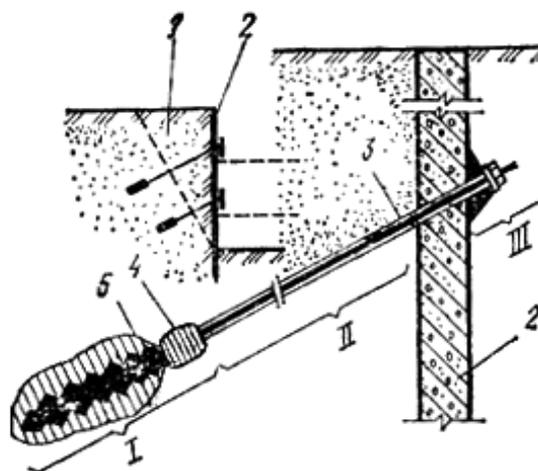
Крепление стены в грунте грунтовыми анкерами инъекционного типа. 1-призма обрушения; 2-стена в грунте (железобетон); 3-тяж анкера (трос); 4-резиновый пакер (уплотнитель); 5-ерш (активная часть анкера); I-заделка (активная часть); II-пассивная часть; III-натяжное (стопорное) устройство (пунктирные линии – глубина разработки грунта в котловане перед установкой очередного анкера).
